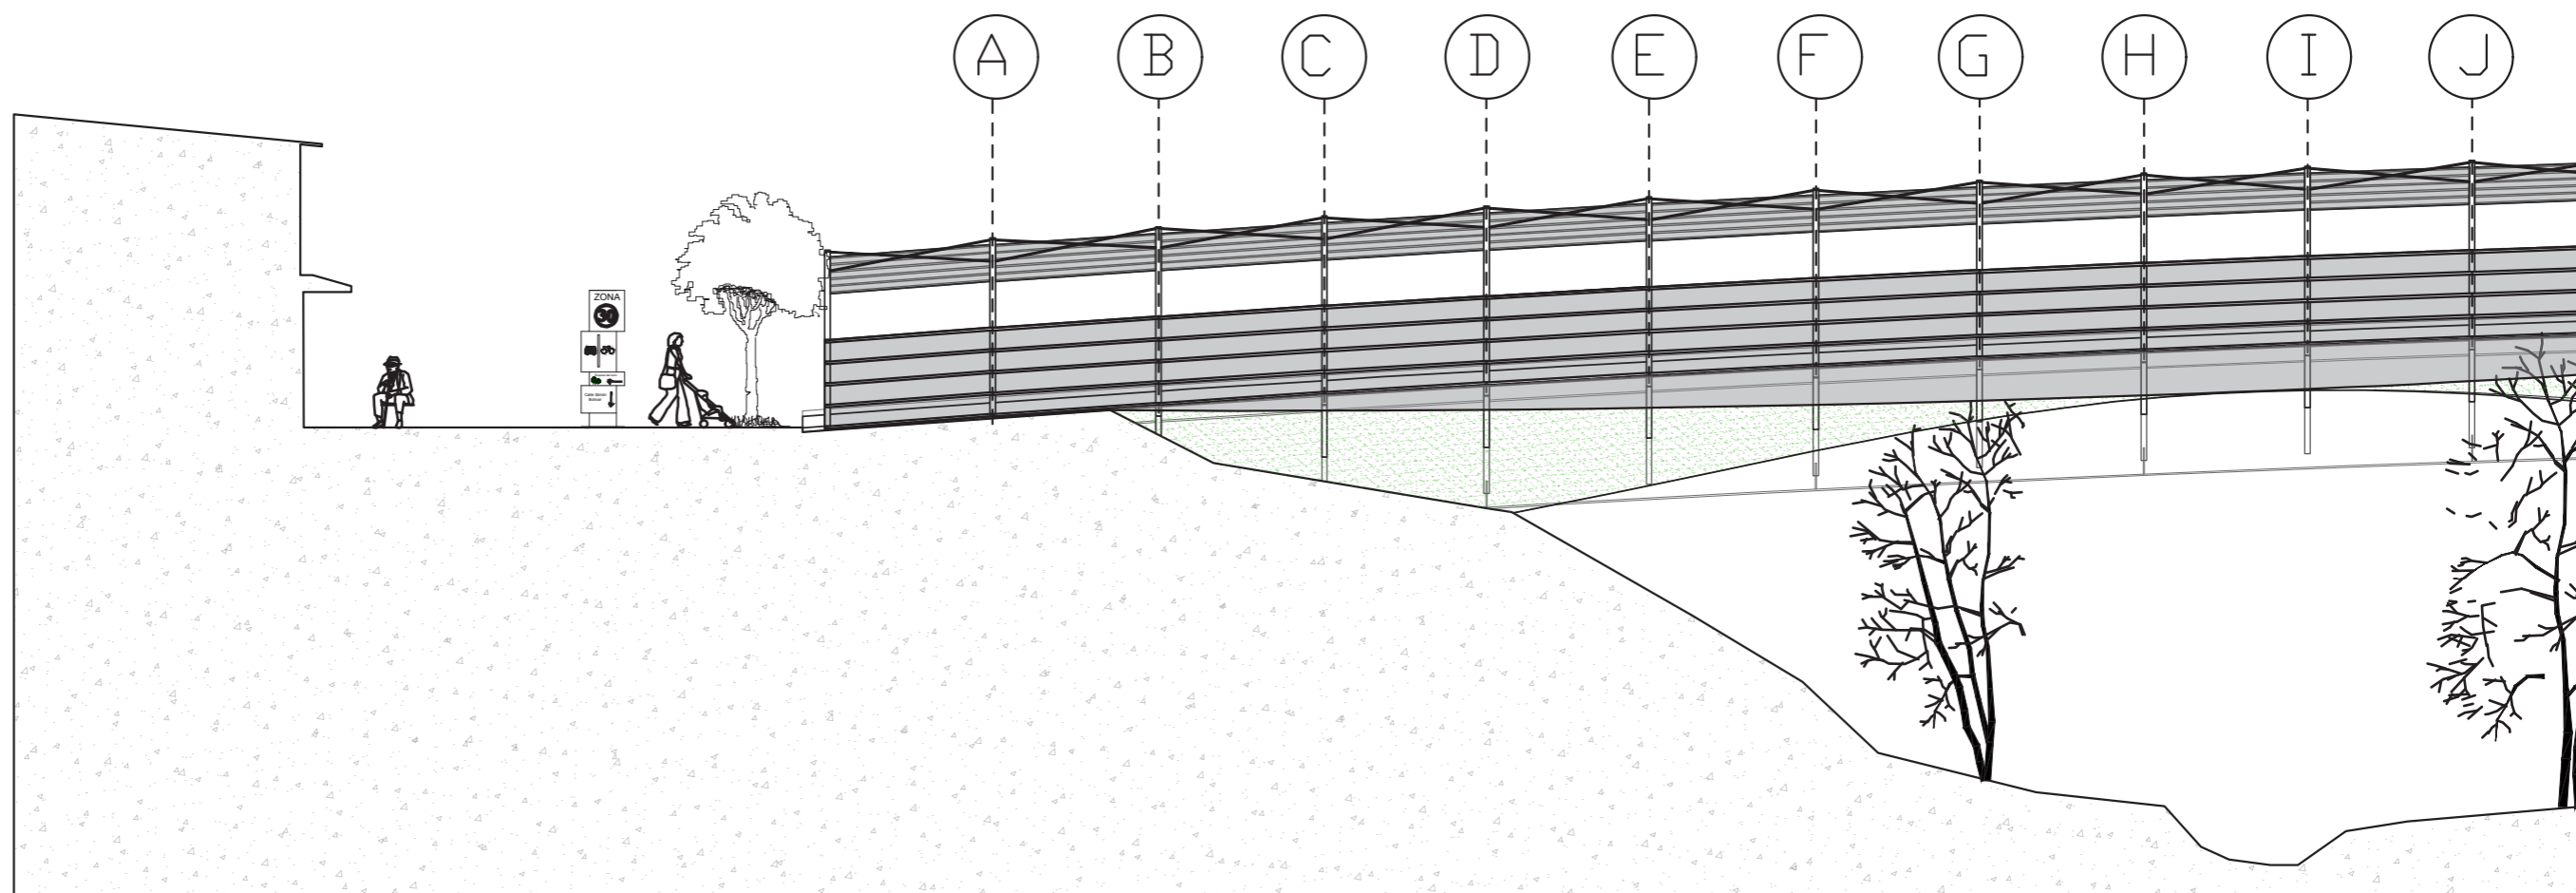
, Planta arquitectónica puente "Tahuando" que conecta las calle Tahuando con la Av. Carlos Barahona.
